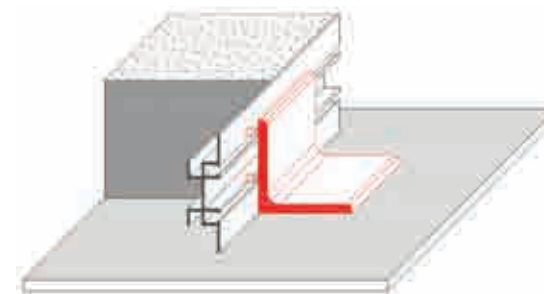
Elementos de fijación del perfil perimetral a la mesa de hormigonado
